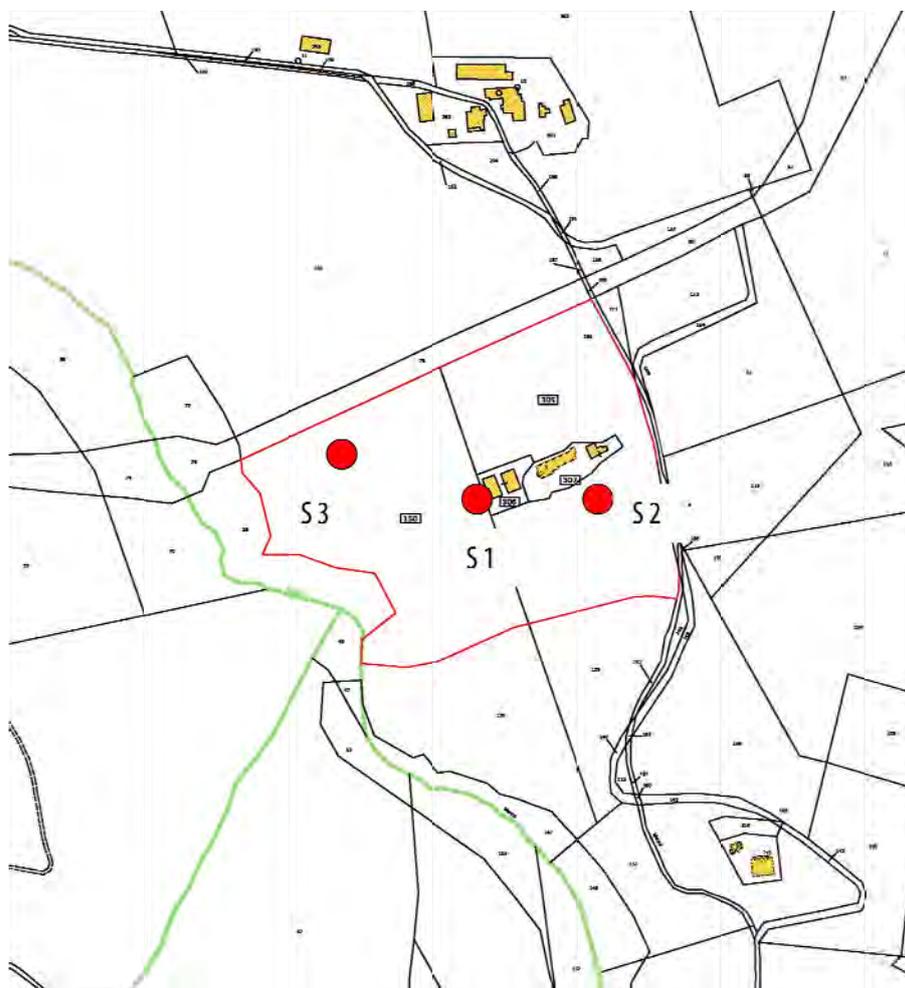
Planimetria catastale con ubicazione dei sondaggi
